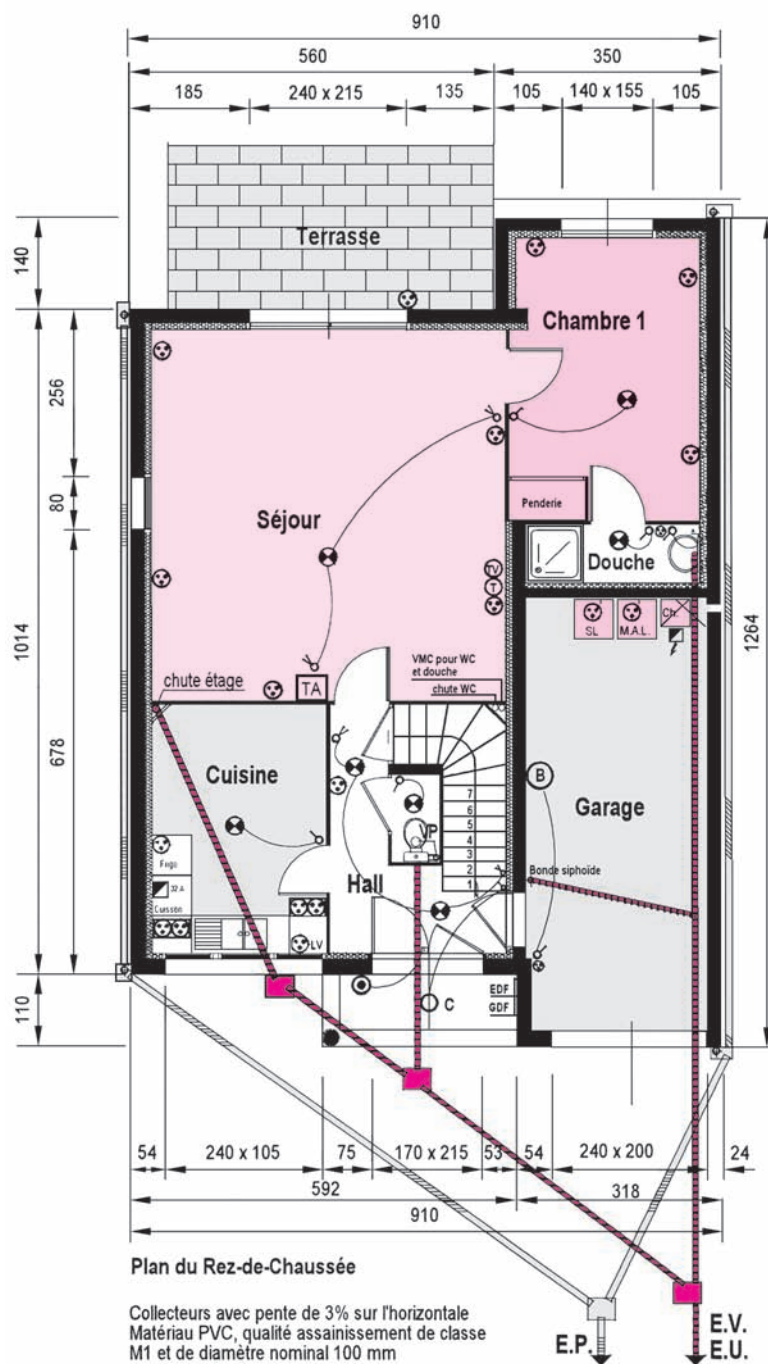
Schéma d'implantation des eaux usées et des eaux pluviales en plan
